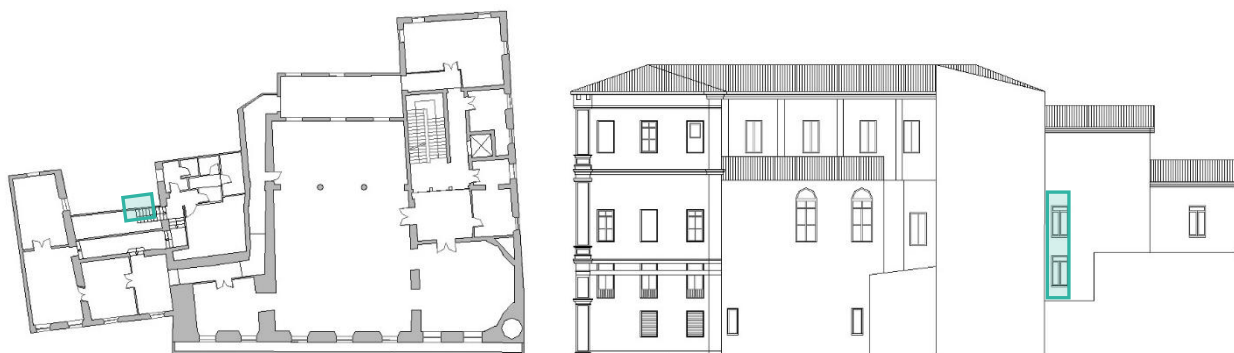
Individuazione macroelemento, pianta e prospetto
